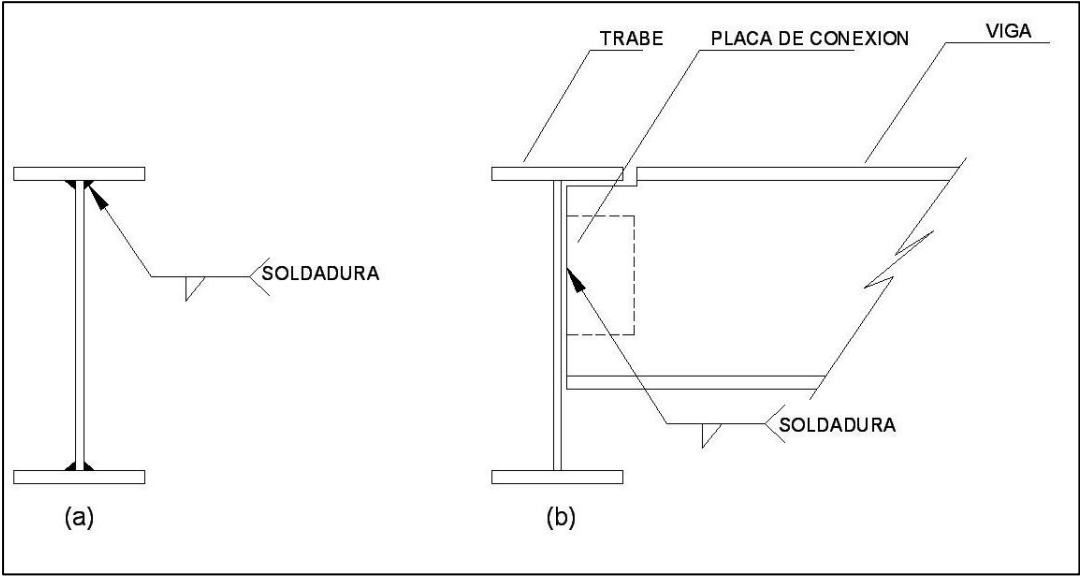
Soldaduras de filete (a) Perfil soldado (b) Placa a cortante
